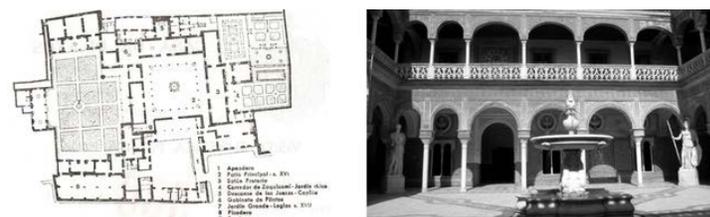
Casa Pilatos, Sevilla. Planta y patio interior. Archivo de Antonio Barrionuevo Ferrer.
